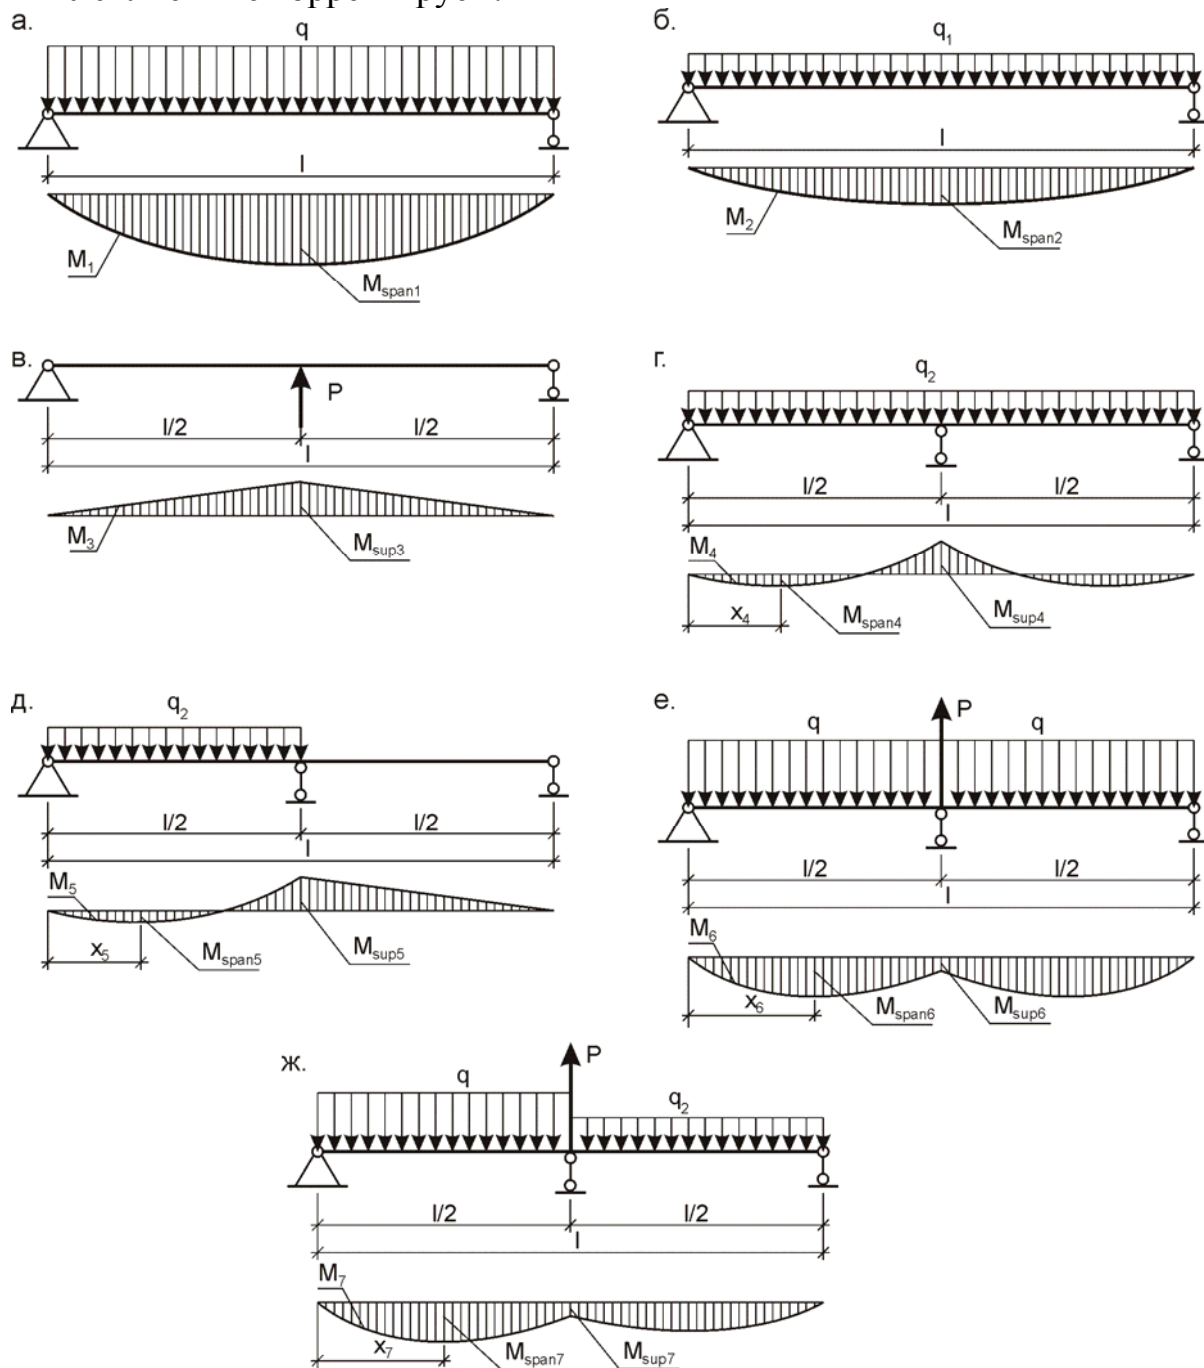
Расчётная схема однопролётной балки, усиленной дополнительной опорой с поддомкрачиванием
